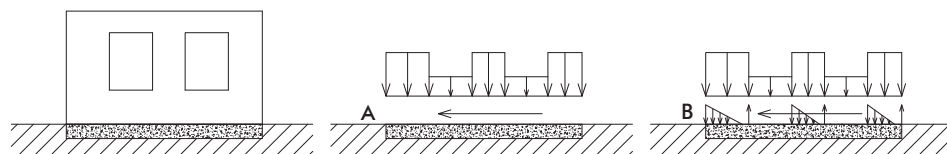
Sollecitazioni sulle fondazioni. A: La schematizzazione non è corretta. B: Schematizzazione corretta ma estremamente complessa da descrivere.
